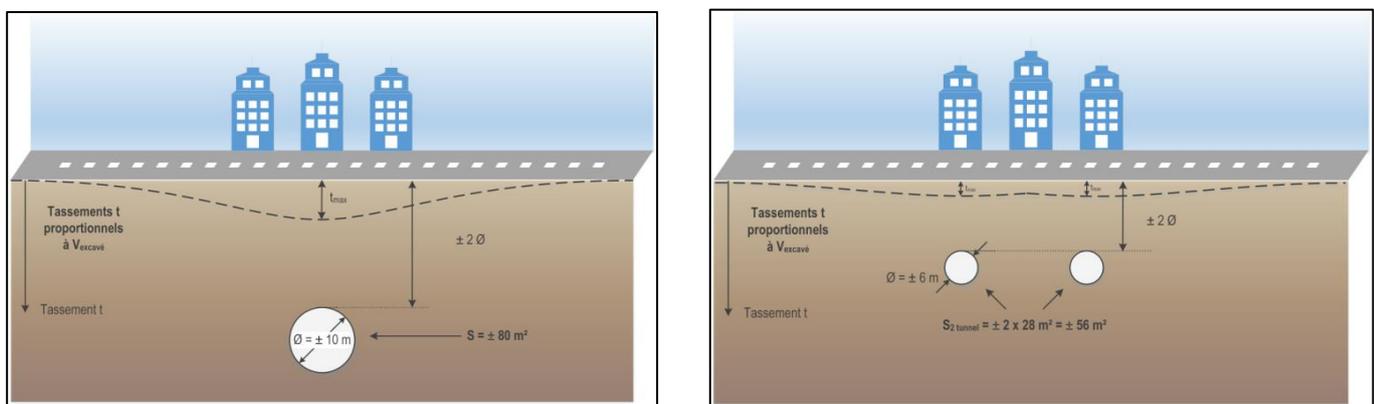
Schémas du risque de tassements dans le cas d'un tunnelier pour 2 voies, ou de 2 tunneliers (un par voie)
